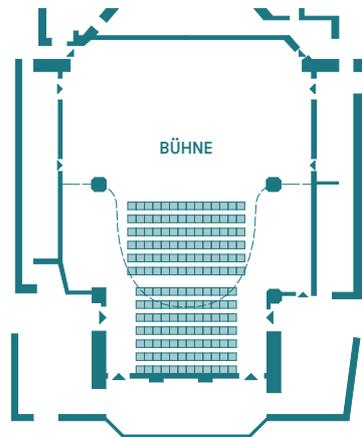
Grundriss Säle Stadthalle D und Stadthalle F
